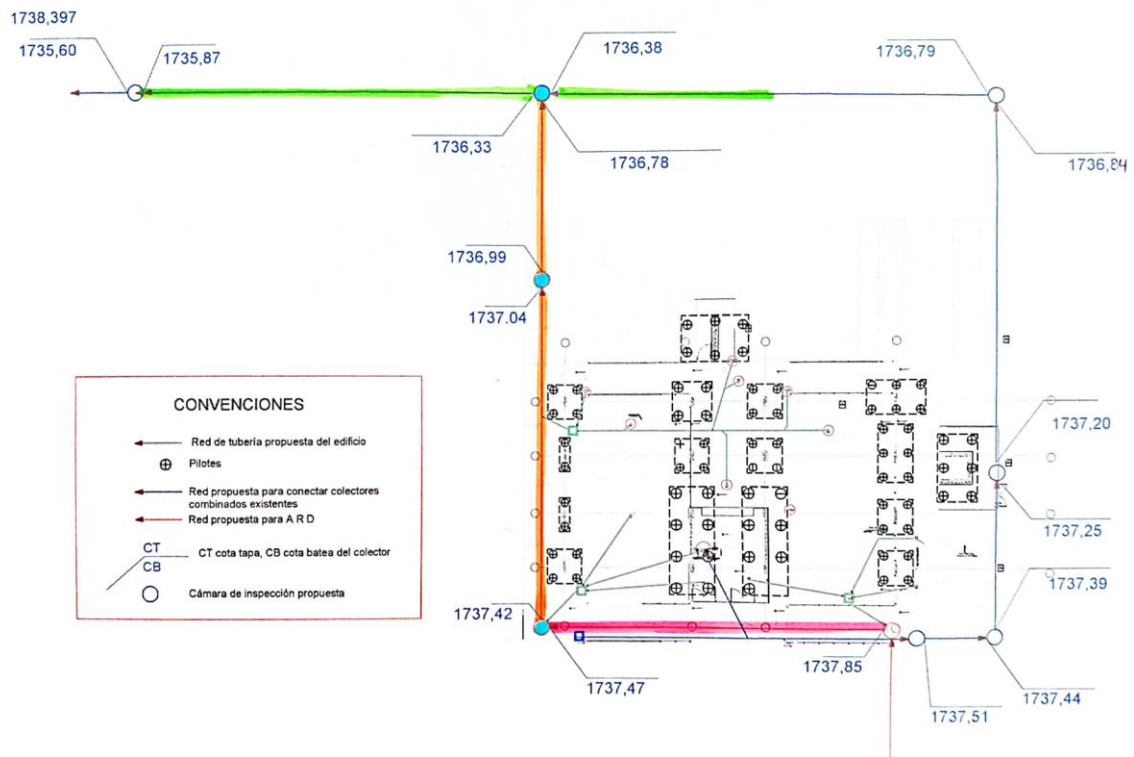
Plano de alcantarillado pluvial y sanitario
